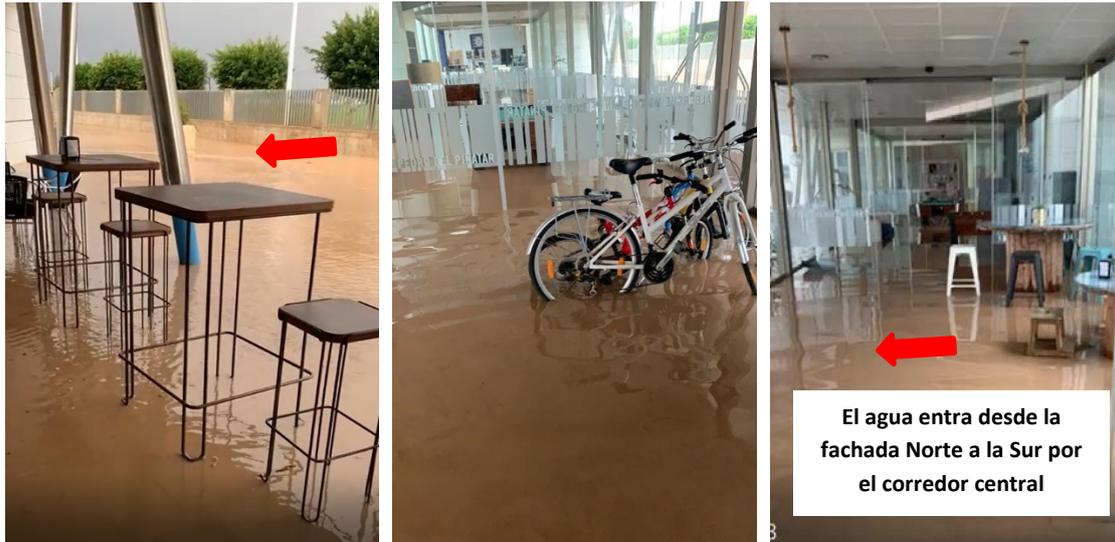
Entrada de agua a través de muro cortina en la fachada norte
